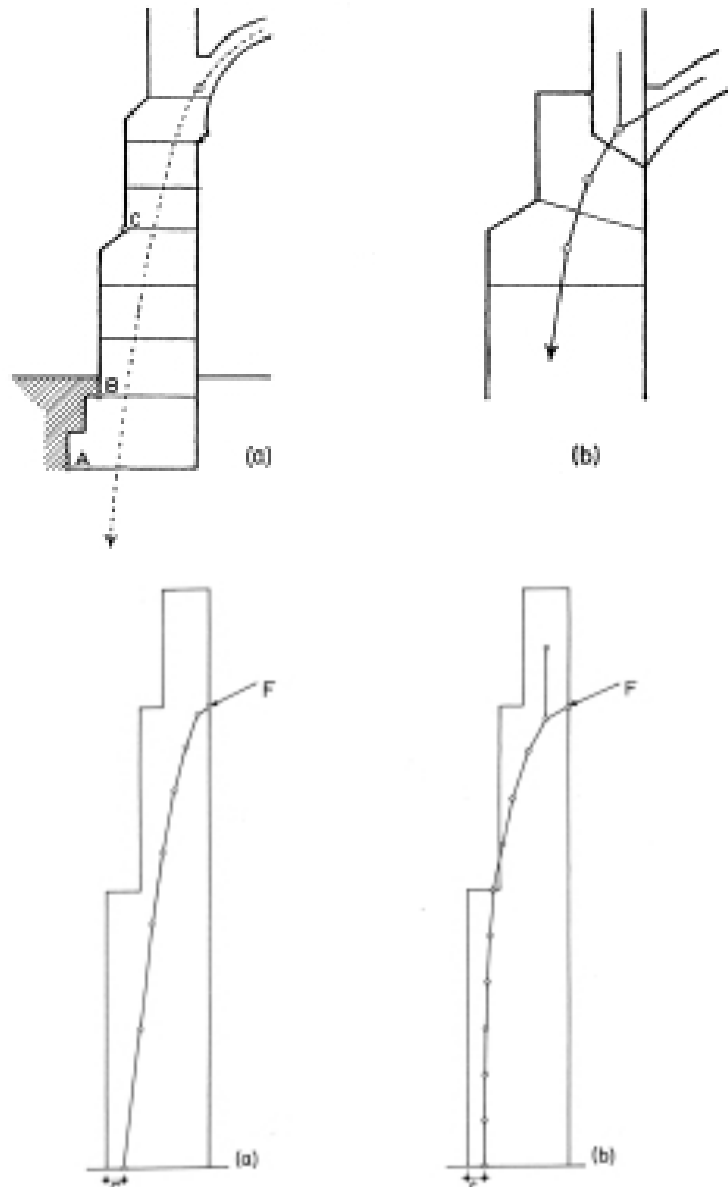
Hiladas inclinadas en puentes de arcos muy rebajados.
